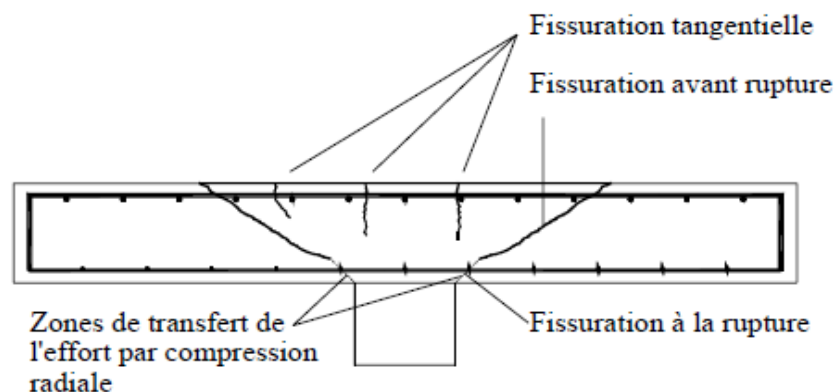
Fissuration lors d'une rupture par poinçonnement [22].
